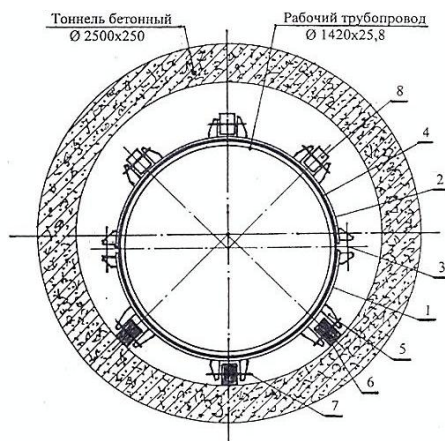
Схема устройства УОЗР.М.3.3.1.1420 (2500x250) с тремя опорными роликами. 1 — нижний полухомут; 2 — верхний полухомут; 3 — болтовое соединение; 4 — прокладка резиновая; 5 — стойка; 6 — ролик опорный; 7 — ось; 8 — ролик защитный
